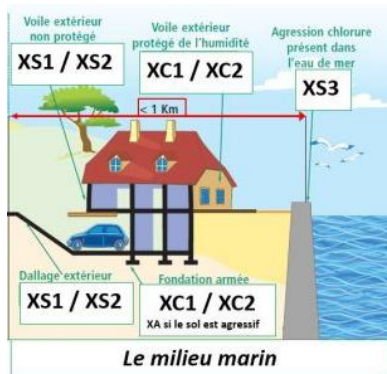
Tableau extrait sur "Tout savoir sur le béton"
